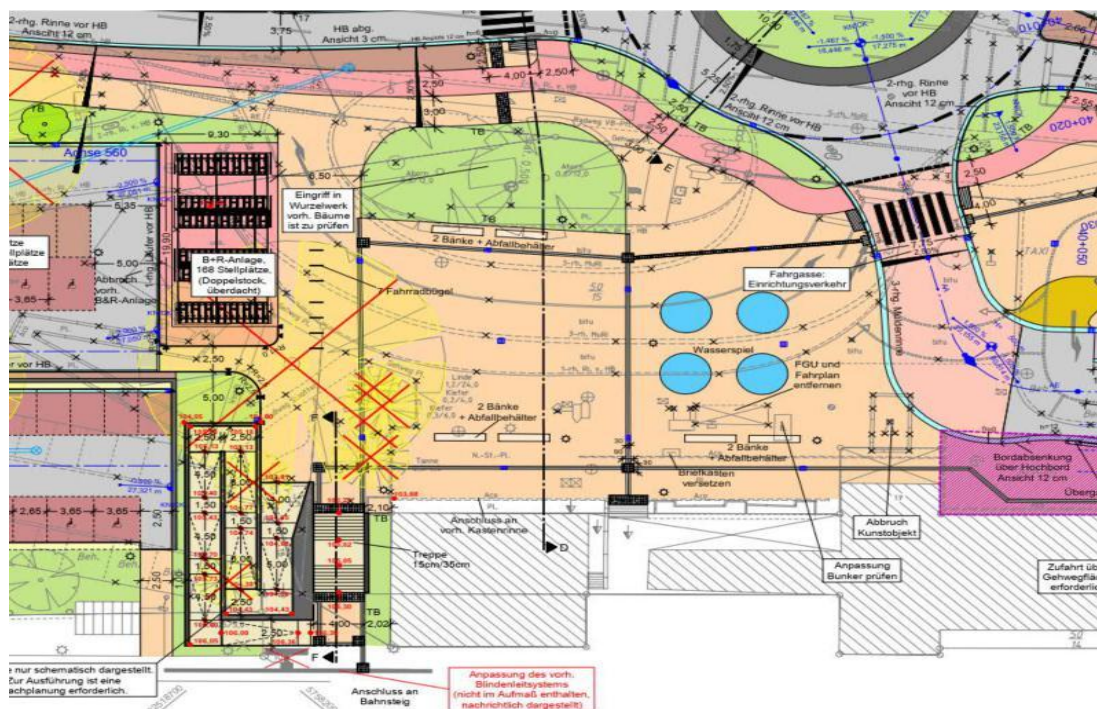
Lageplan Bereich Bahnhofsvorplatz
